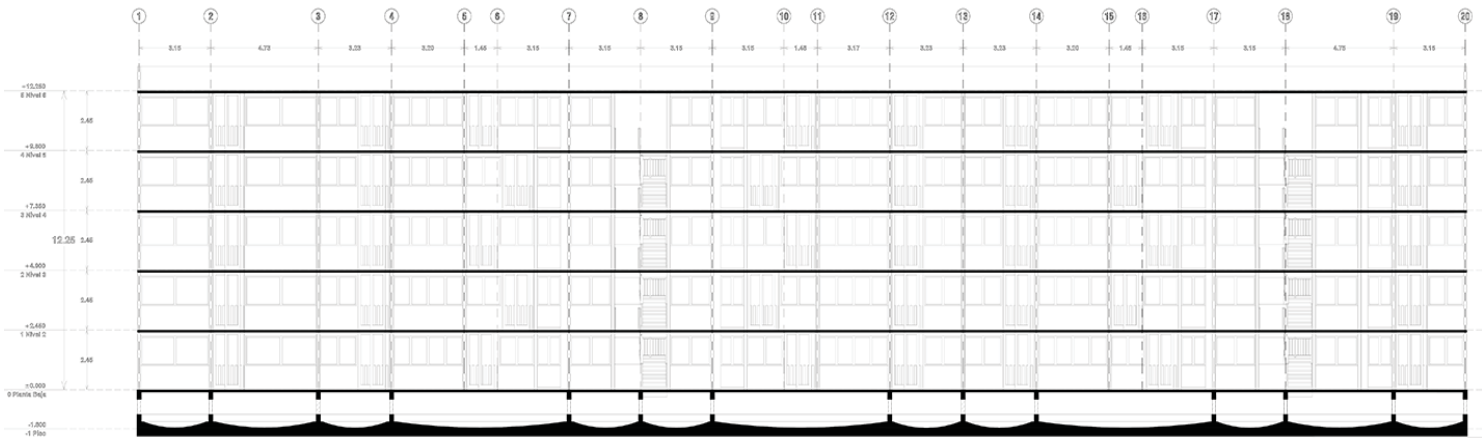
Fachada edificio 2A .obras.cdmx.gob.mx
